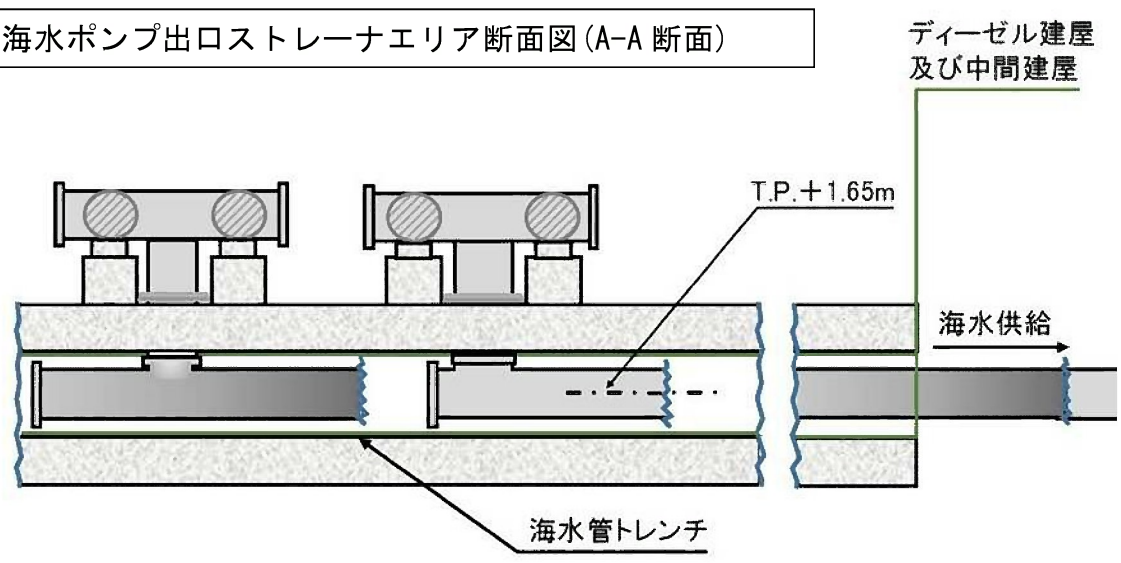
海水ポンプ出口ストレーナエリア 平面・断面図
